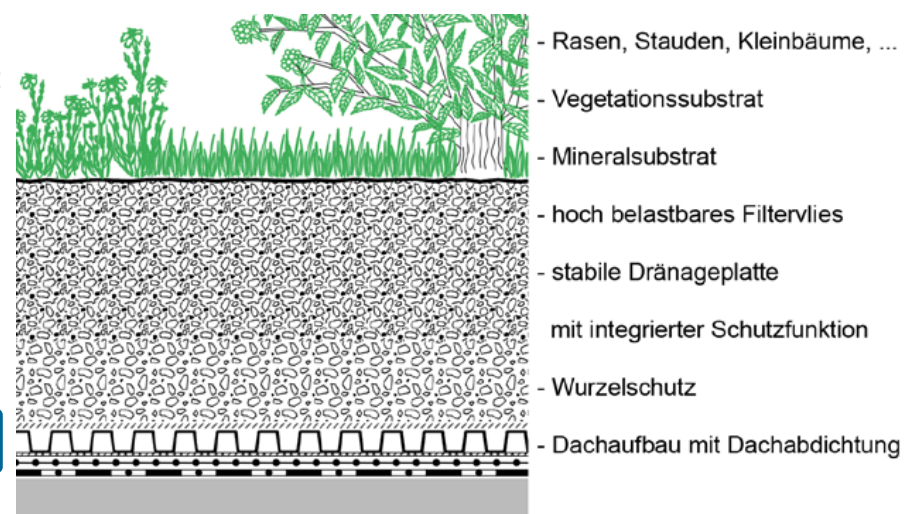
Systemaufbau - Intensivbegrünung auf einer Tiefgaragendecke
